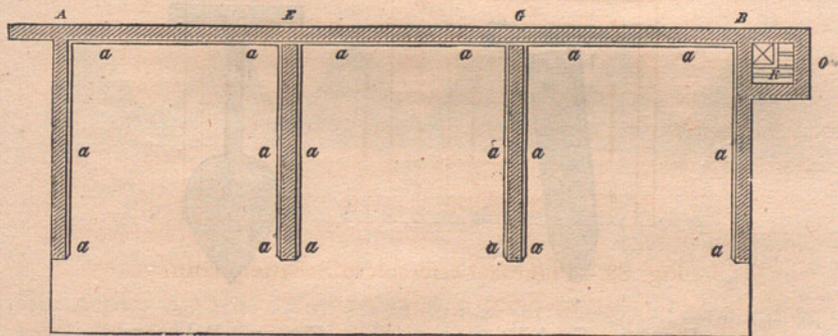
Plano del cobertizo de Mr. Baibaud Lange.
